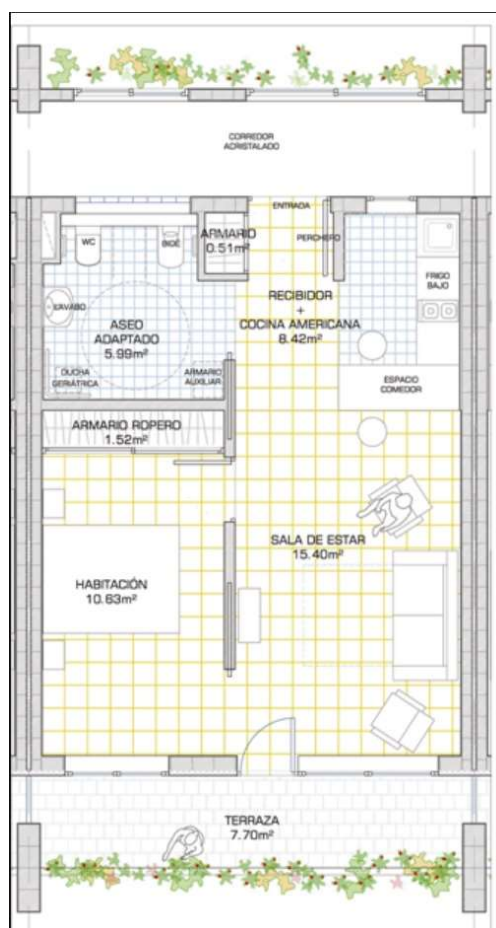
Planta das habitações em Travensol.<sup>25</sup>
